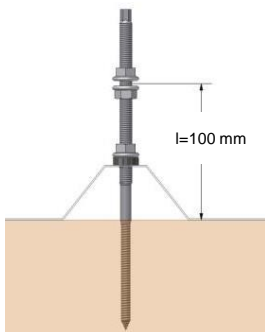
Montierte Stockschraube mit Universalverbinder
